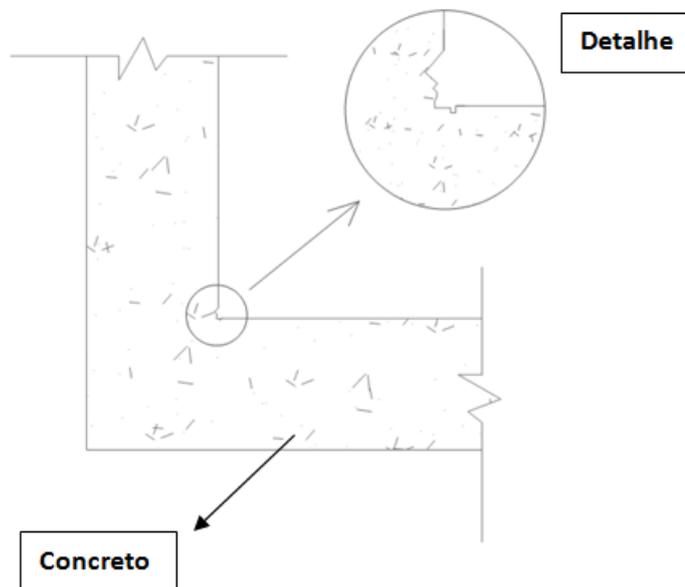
Falhas de concretagem nos encontros – Fonte: O autor
